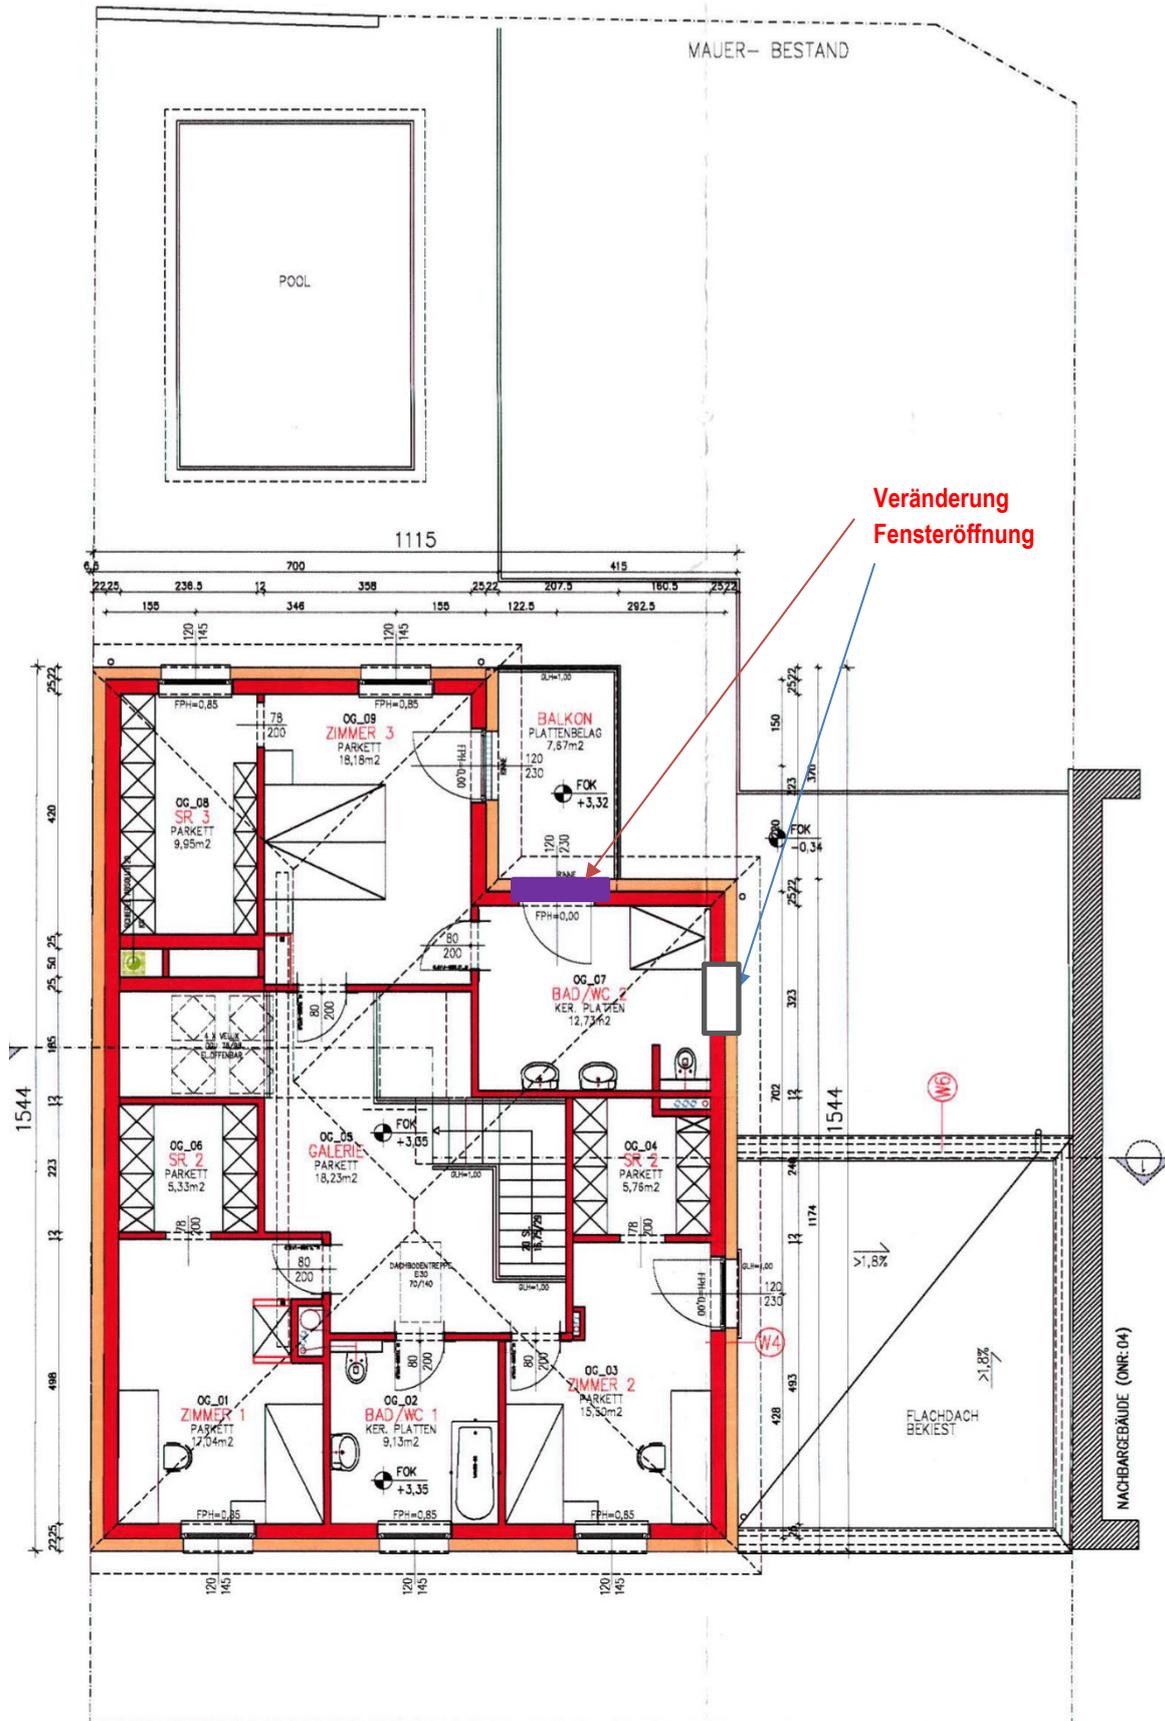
Grundriss Obergeschoss | Einreichplan | Pongratz Bau GmbH (gezeichnet von Dipl.-Ing. Gassenbauer) | 01.04.2010
